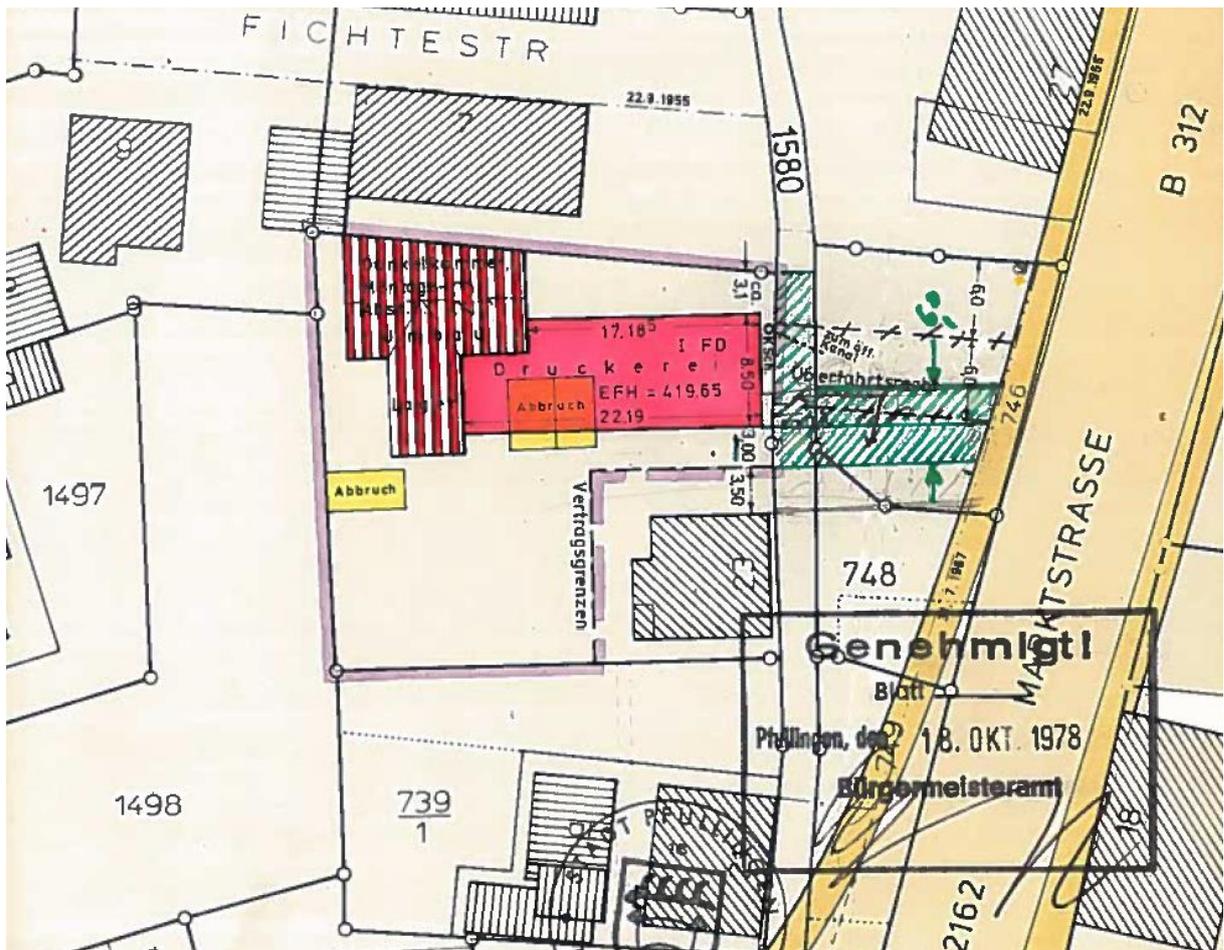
Lageplan zur Baugenehmigung der derzeitigen Bebauung Flurstück 746 (ehem. 748) mit Darstellung des Übergangsrechts, Quelle: Stadt Pfullingen, 1978
